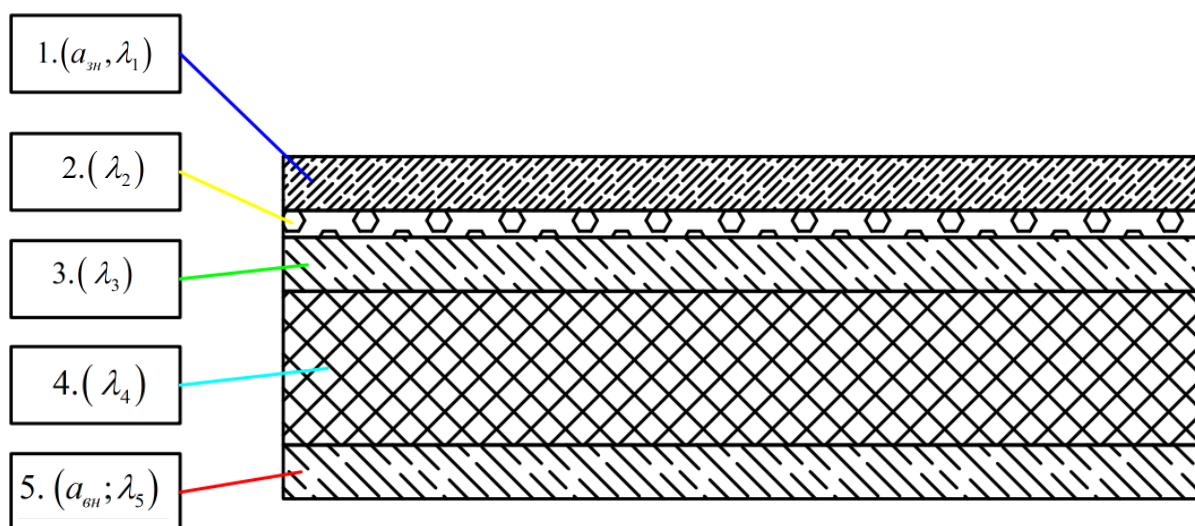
Поперечний розріз нижнього перекриття
